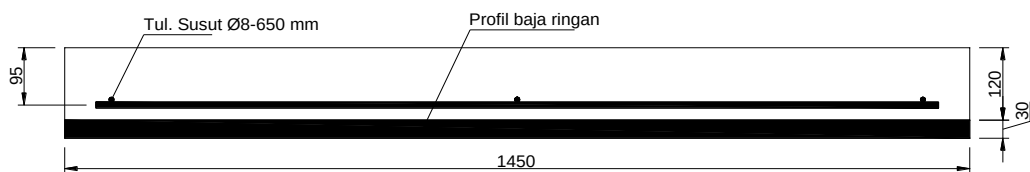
Detail penulangan pelat beton bertulang setelah perkuatan
